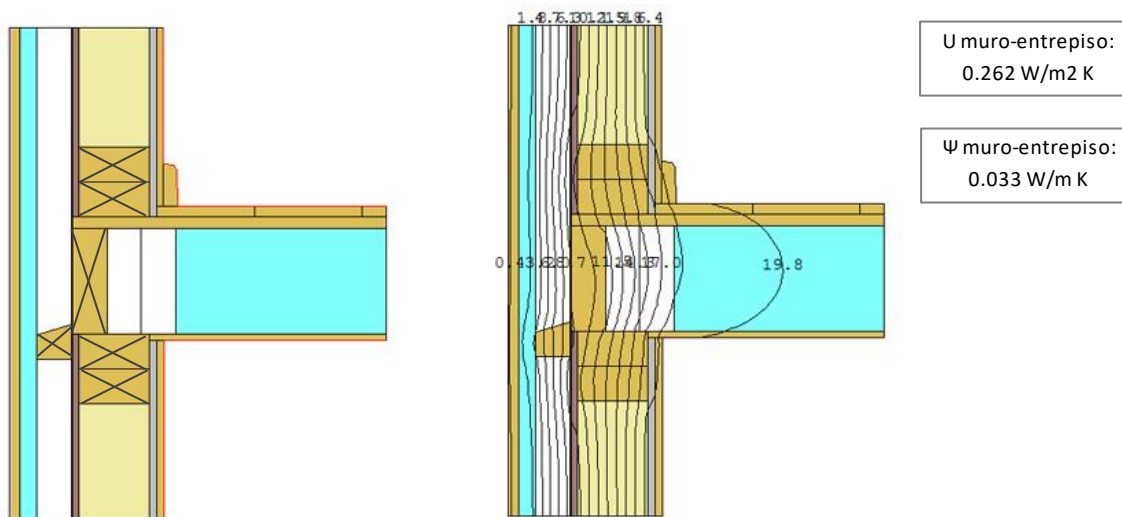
Detalle y diagrama de isotermas unión muro - entrepiso, en vista de corte con tabiquería 2"x4" con aislación rígida
